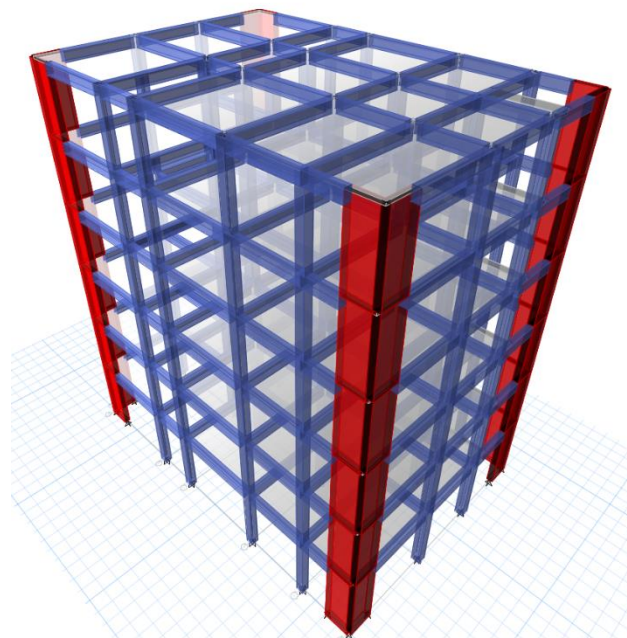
Vista de elementos estructurales – Edificio de 6 piso.
